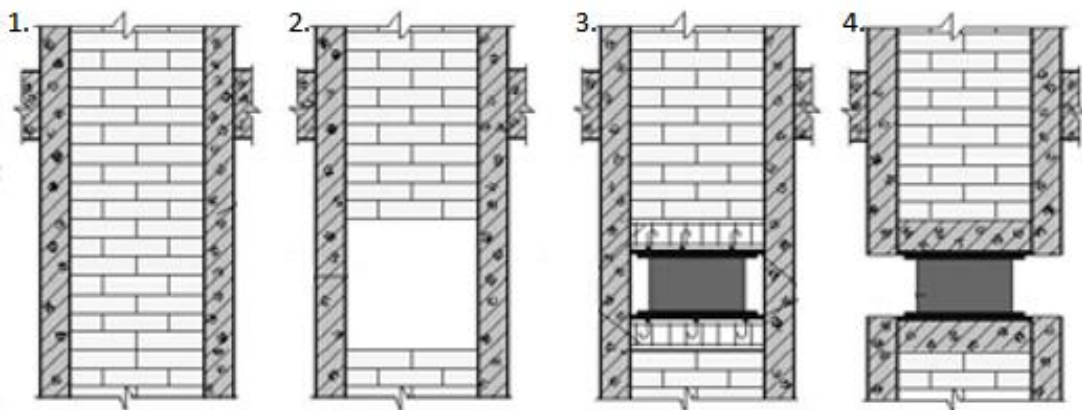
Procedimento de instalação de isoladores em colunas de alvenaria (adaptado de Melkumyan, 2014)
